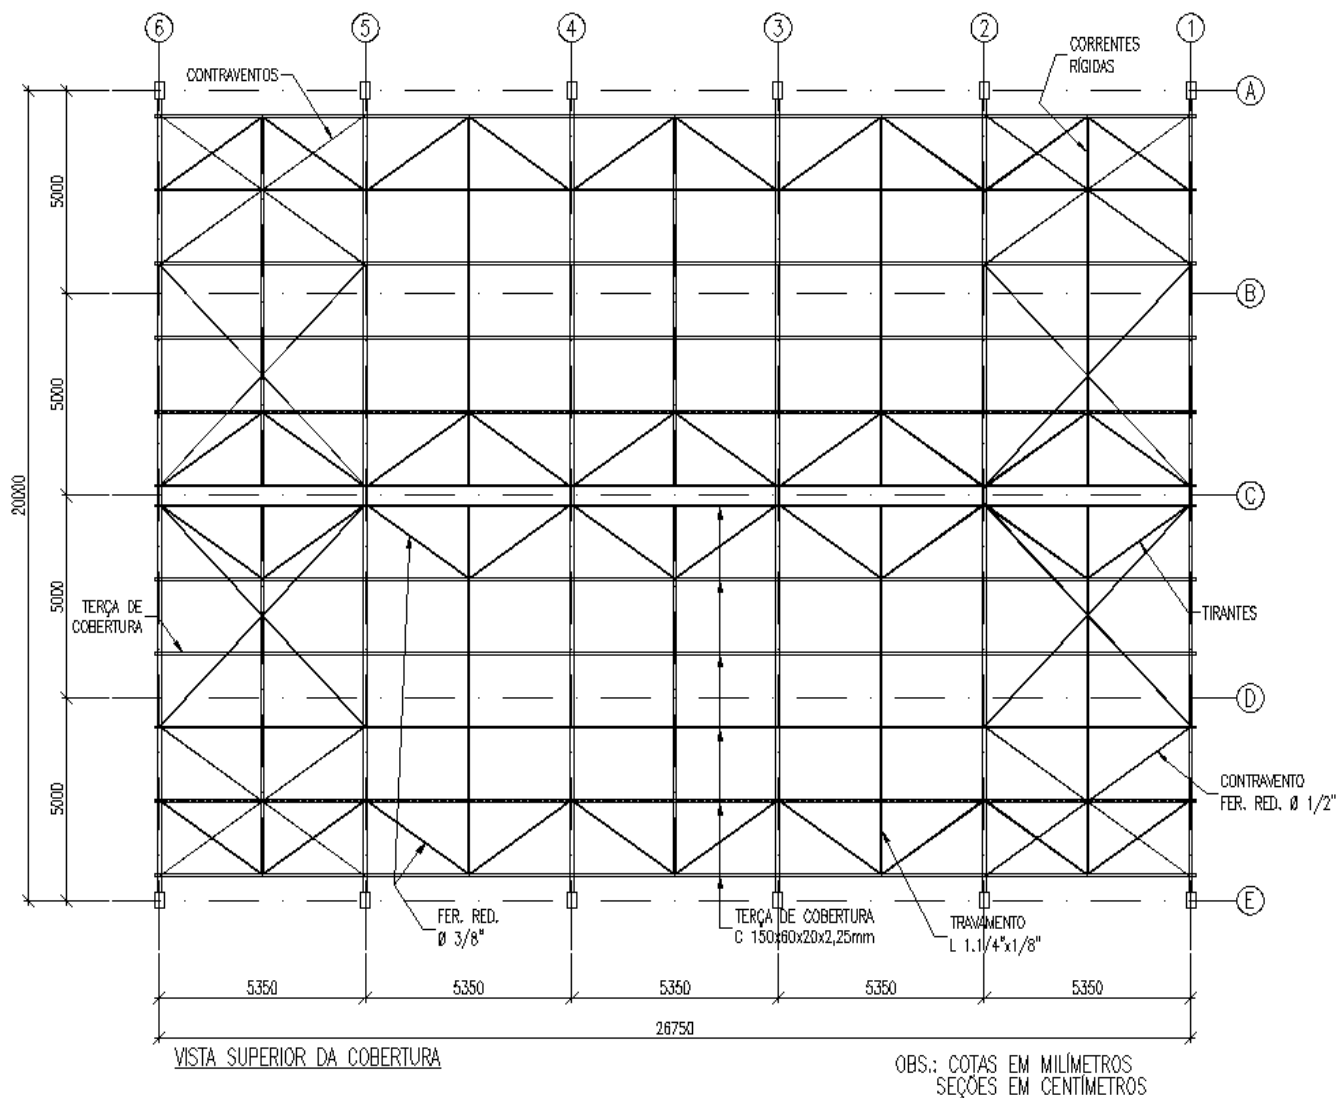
Vista superior da cobertura para estrutura em concreto pré-moldado.
